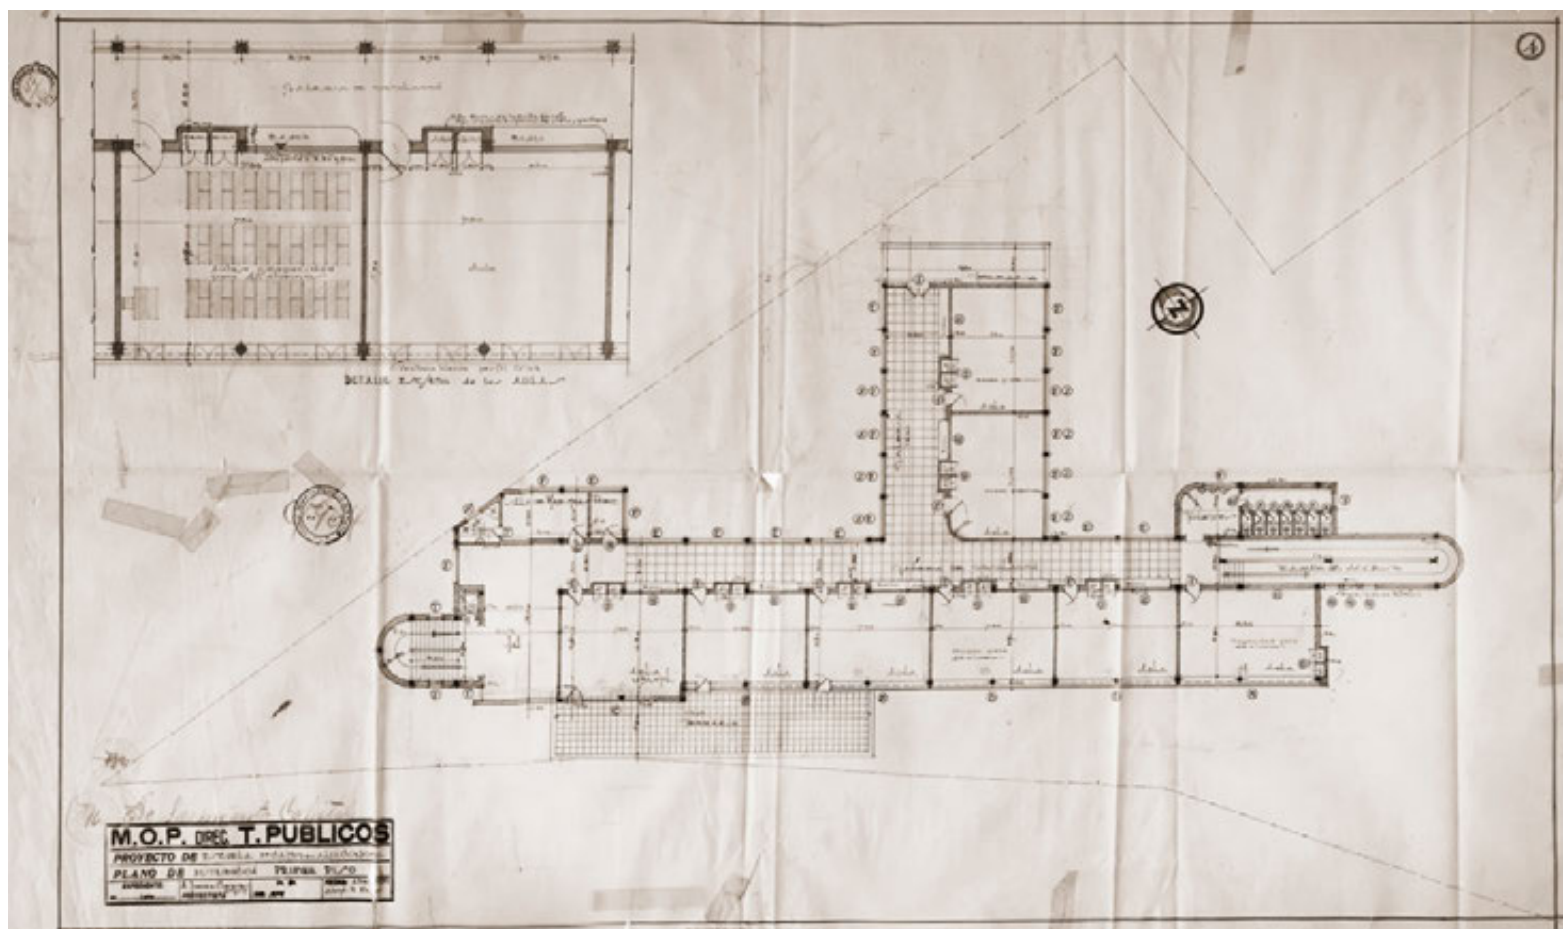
Escuela Presidente Sarmiento. Planta primer piso (Archivo de la Secretaría de Arquitectura de la Provincia de Córdoba).
